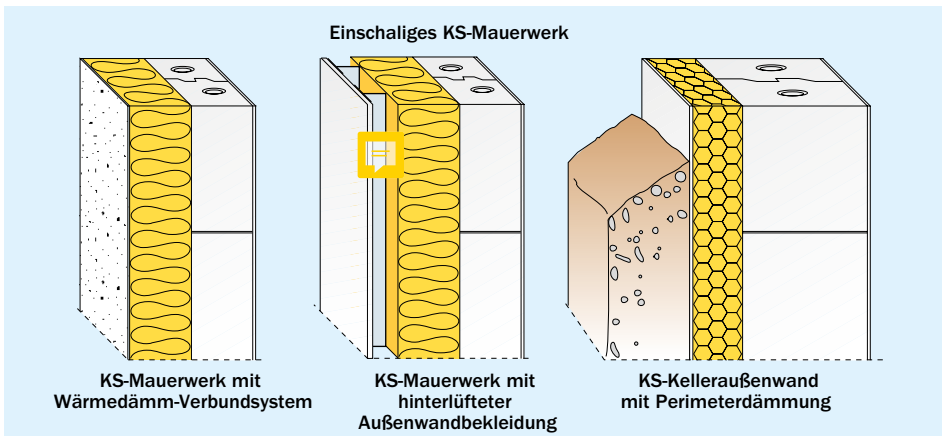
Einschalige KS-Außenwandkonstruktionen für beheizte Gebäude
